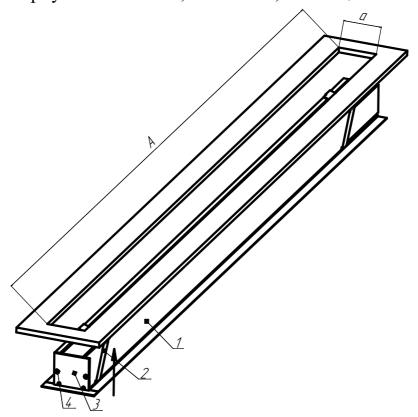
Схема установки светильников в потолок 1 - светильник; 2 - скоба; 3 - крышка торцевая ДВО02; 4 - саморезы;
